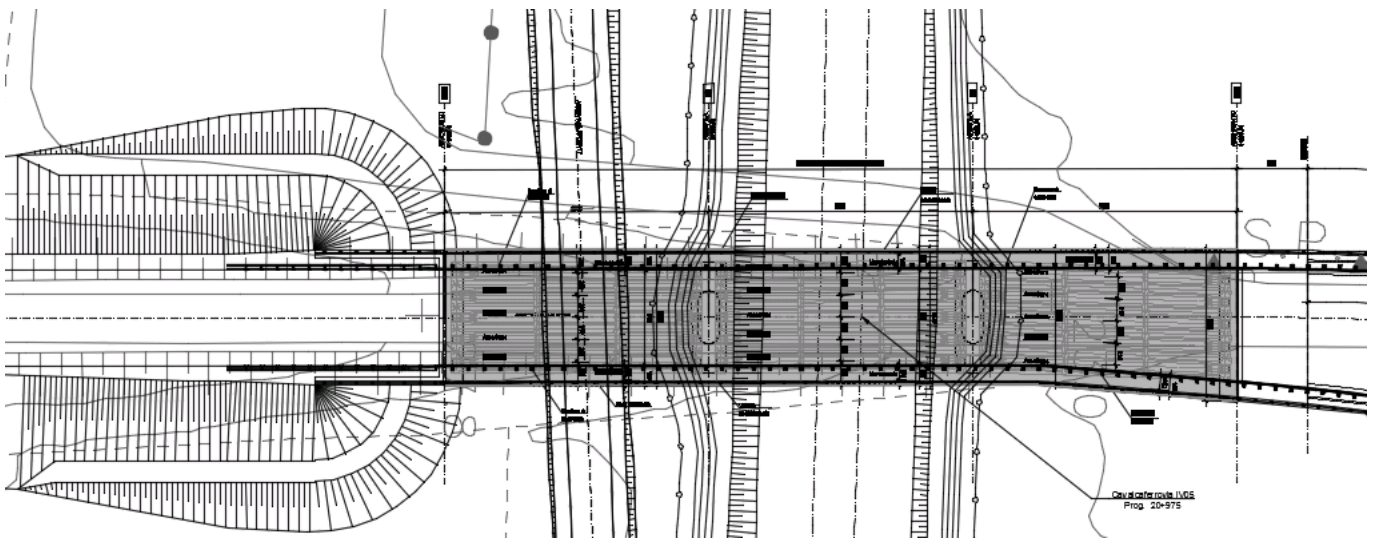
Stralcio planimetrico – ubicazione opera d'arte
